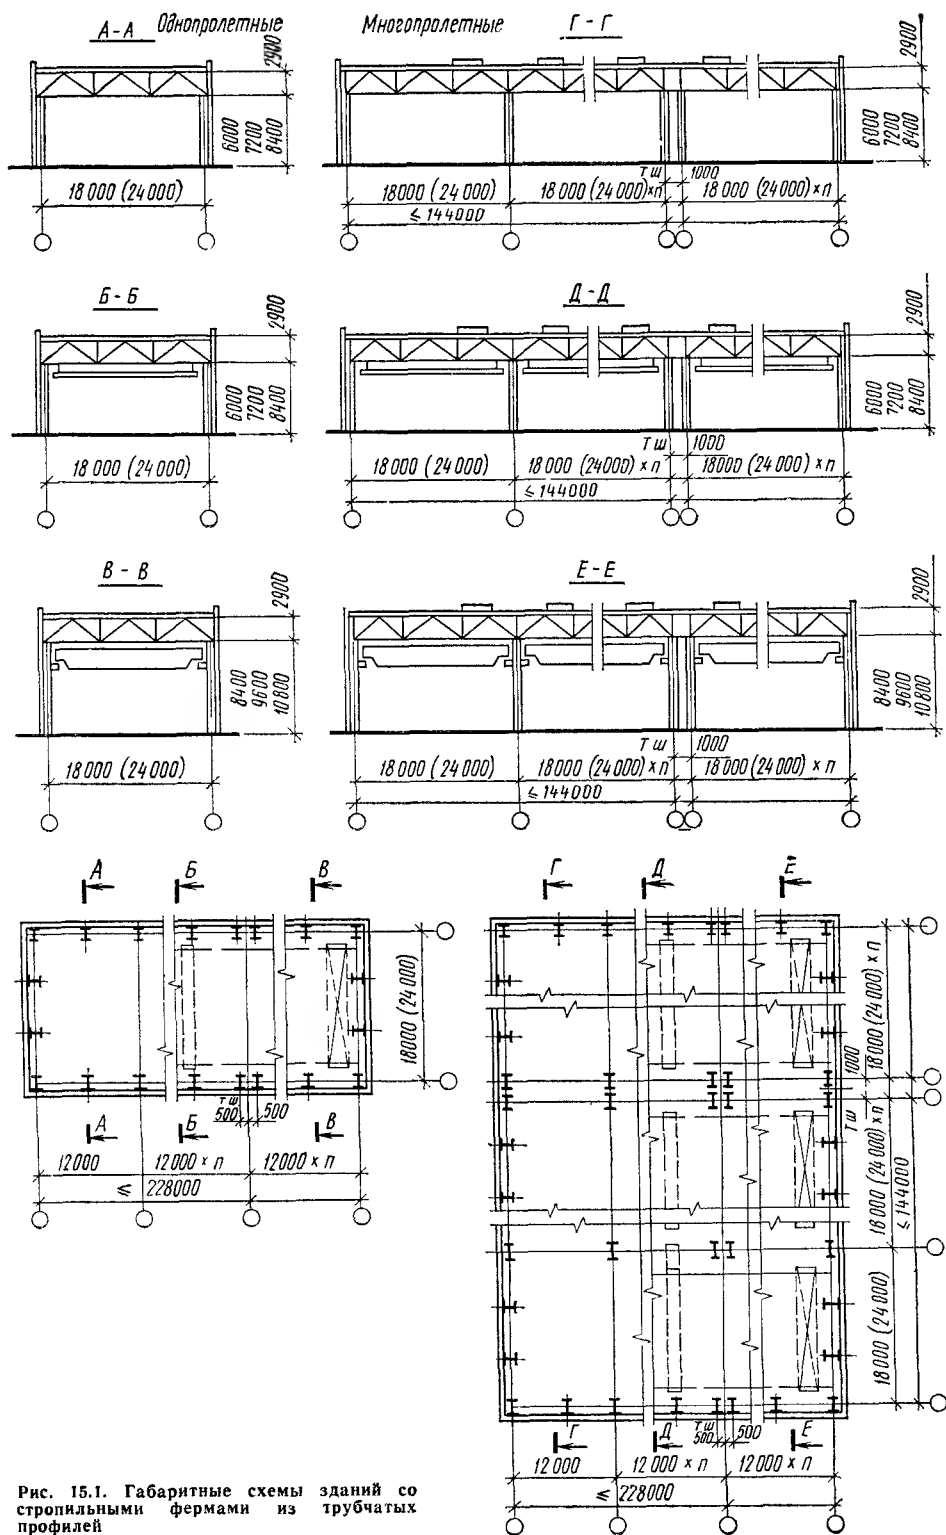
Габаритные схемы зданий со стропильными фермами из трубчатых профилей
